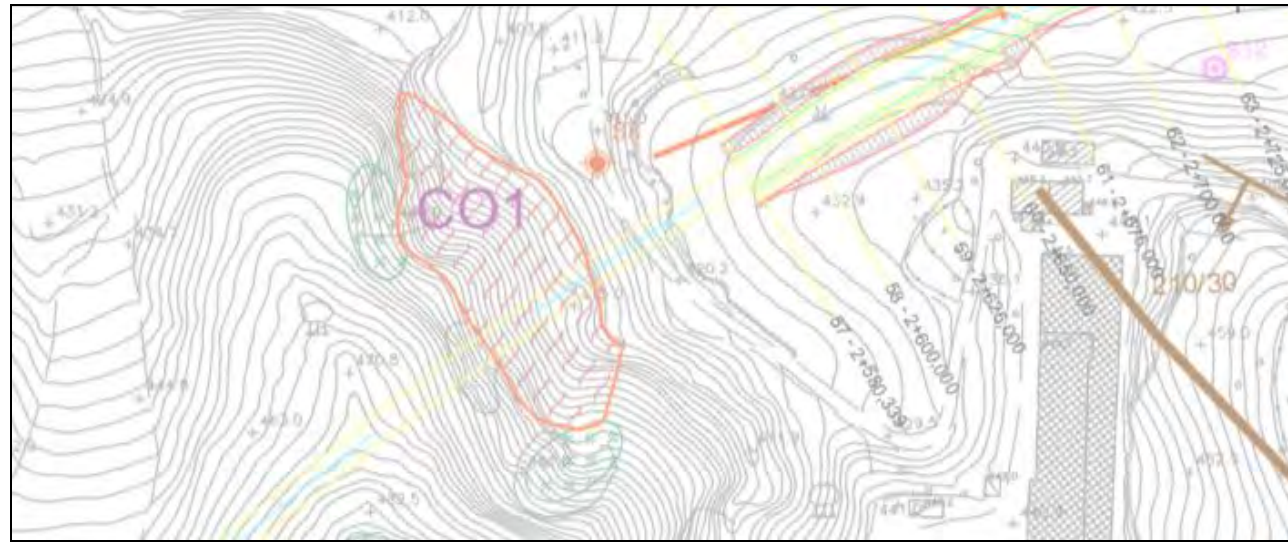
Stralcio planimetrico con dettaglio fenomeno di colamento
